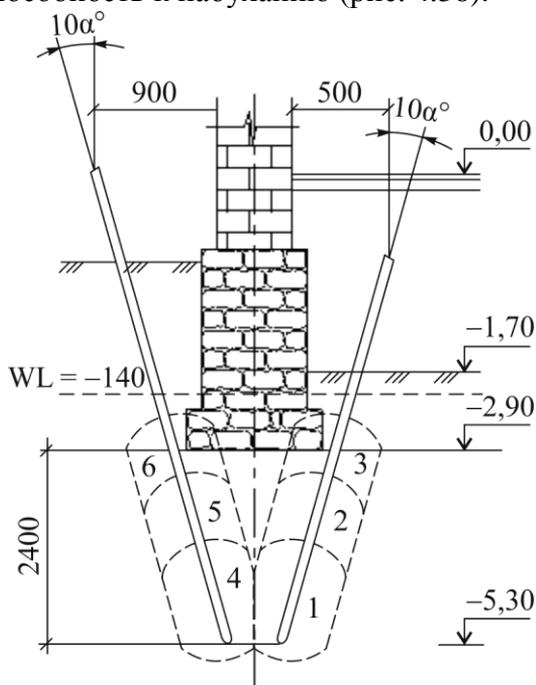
Электрохимическое закрепление слабых грунтов в основании фундаментов: 1–6 – номера захваток
